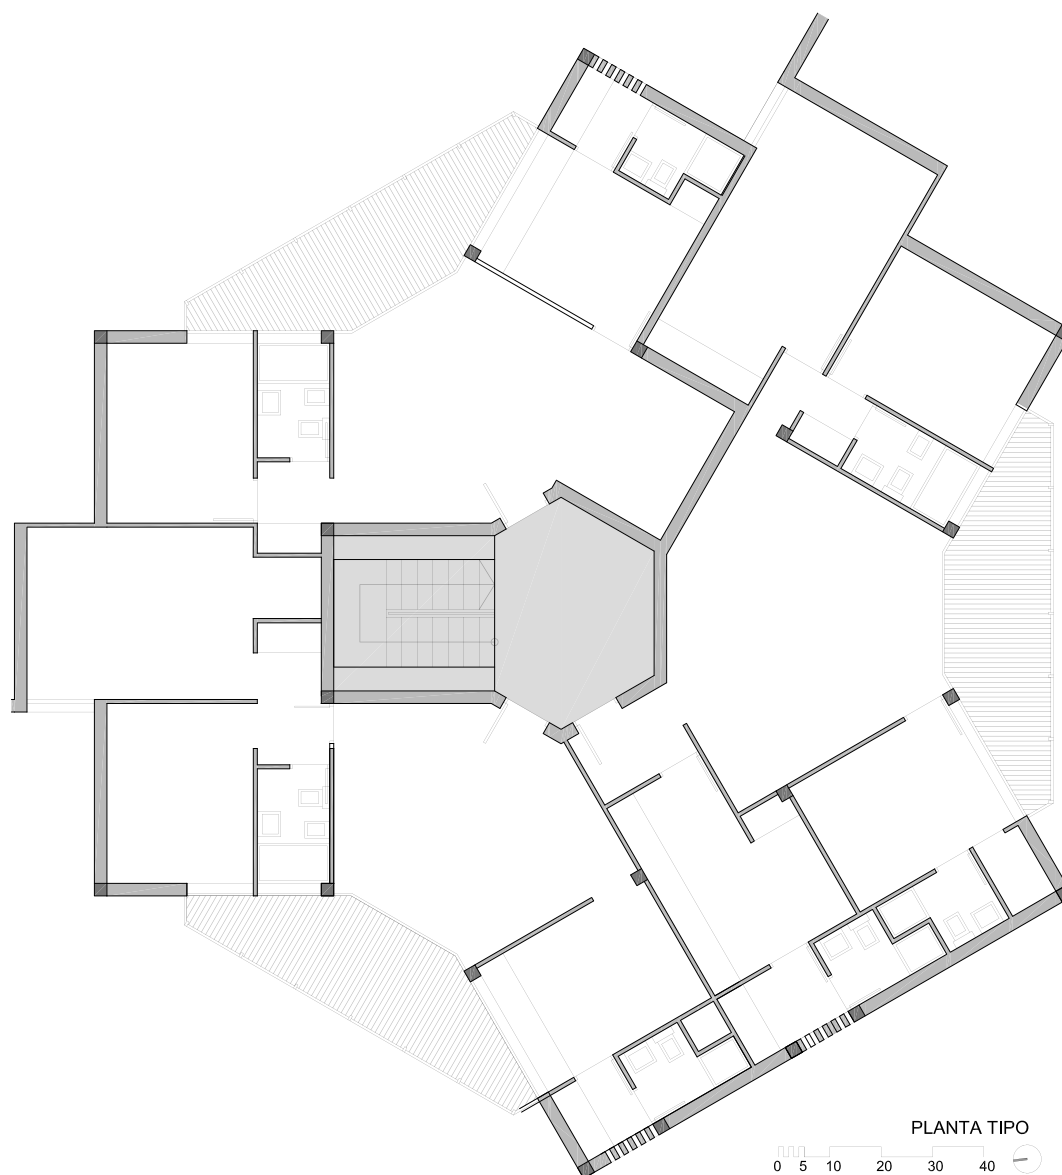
Planta tipo de un módulo hexagonal del basamento. Elaboración propia
